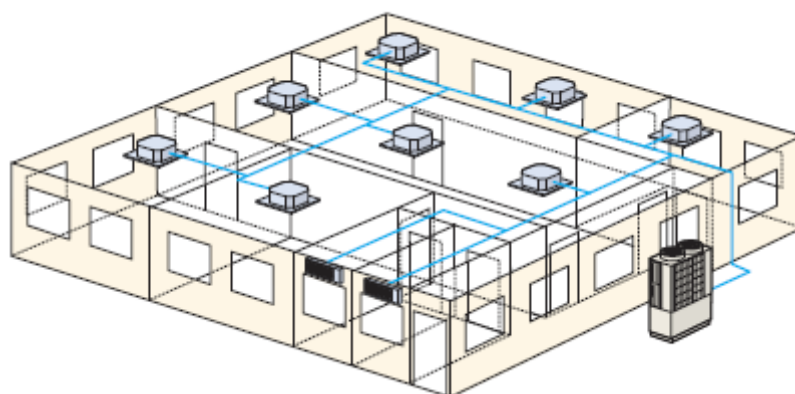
Esquema de las bombas de frío-calor. Fuente: Catálogo técnico del fabricante.
